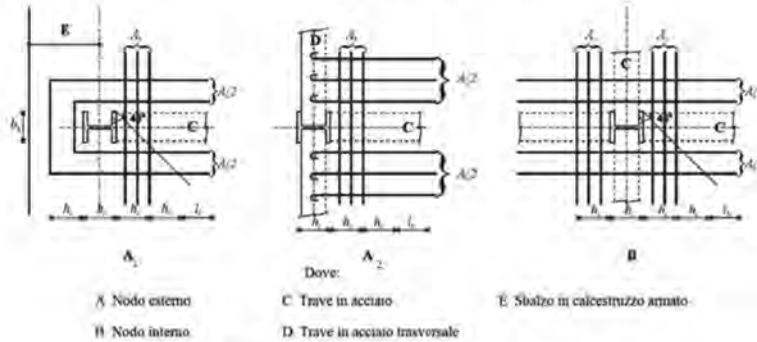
Dettagli di armatura in corrispondenza dei nodi trave-colonna
